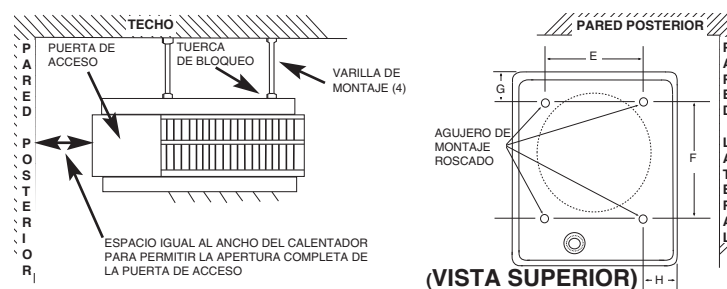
Montaje de descarga vertical y espaciado entre varillas
